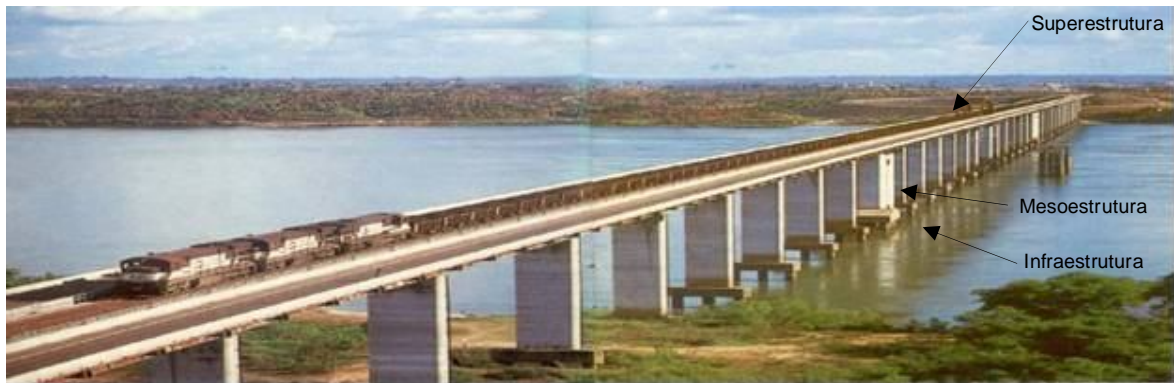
Foto da ponte existente sobre Rio Tocantins
